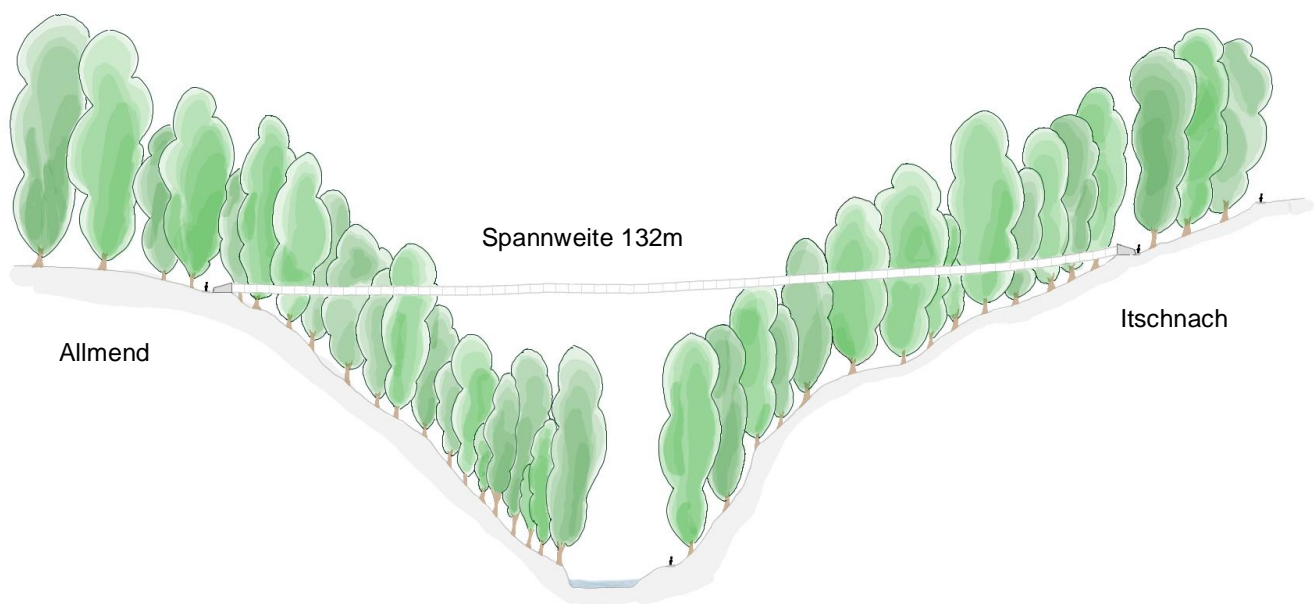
Ansicht Brücke inkl. Wald (Darstellung massstabsgetreu)
